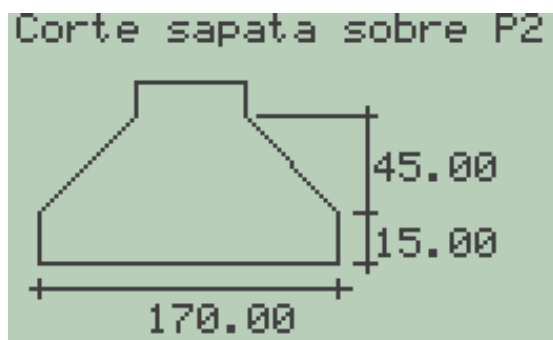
Viga alavanca - Detalhamento da seção transversal da sapata sobre P2.
